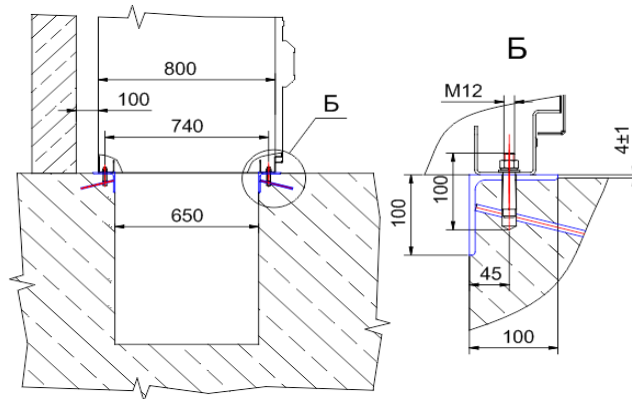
Пример конструкции фундаментной рамы и кабельного канала, выполненного из уголков.
